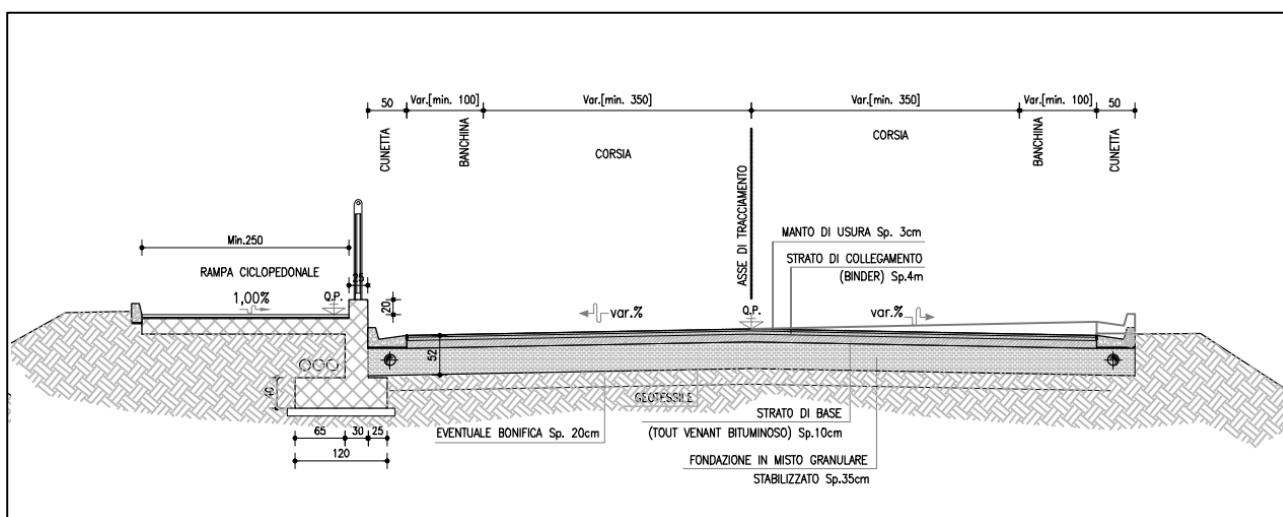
Sezione tipo asse principale con pista ciclopedonale
